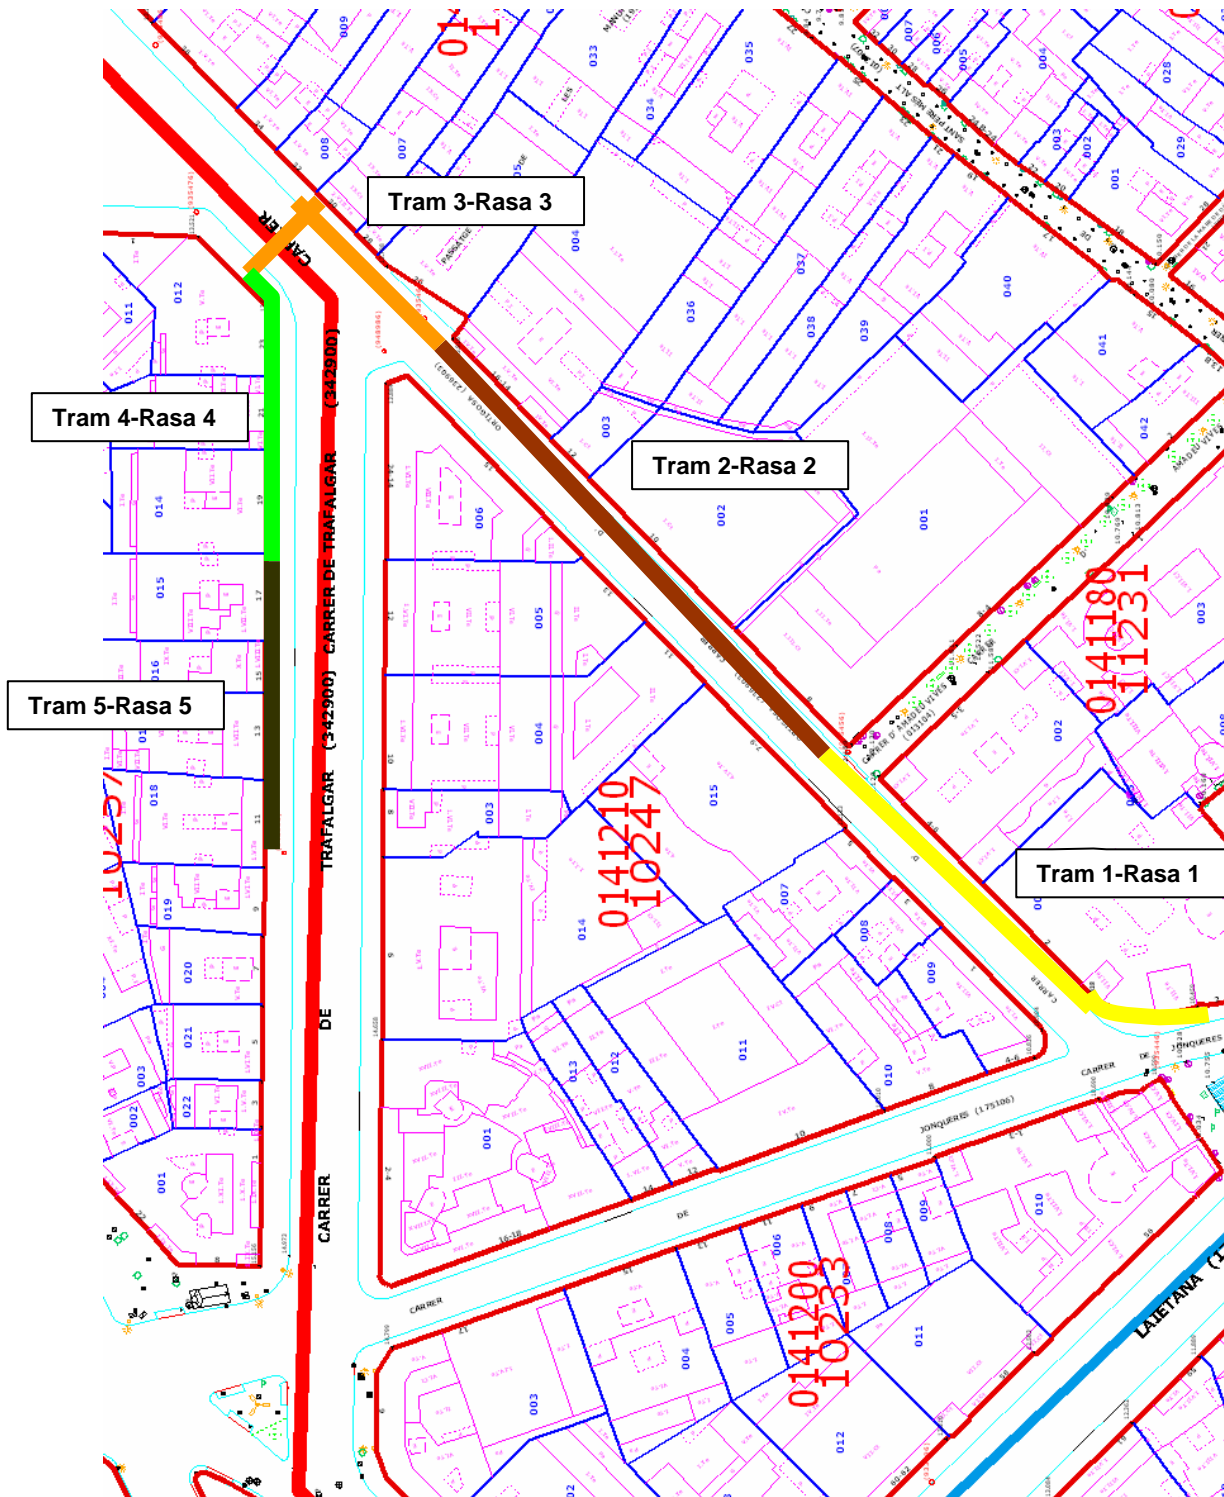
Divisió de trams de la intervenció, segons planimetria de FECSA-ENDESA
